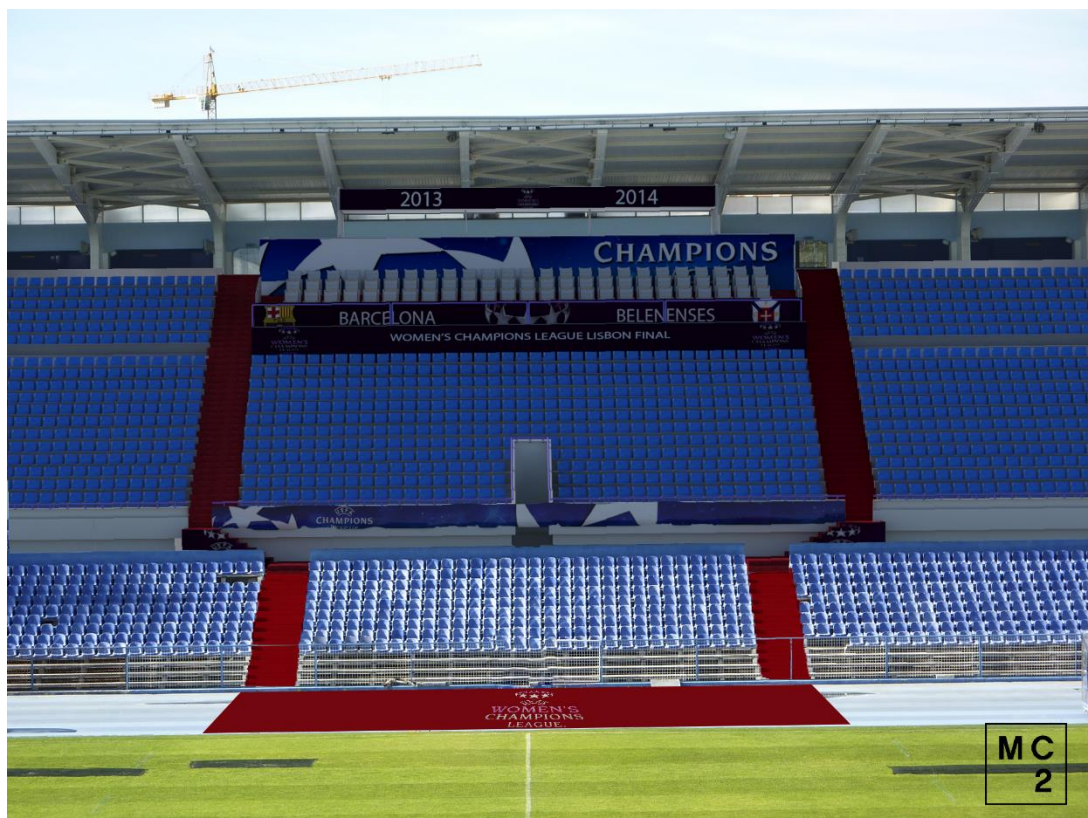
Renderização 3D Vista da bancada oposta para a intervenção
